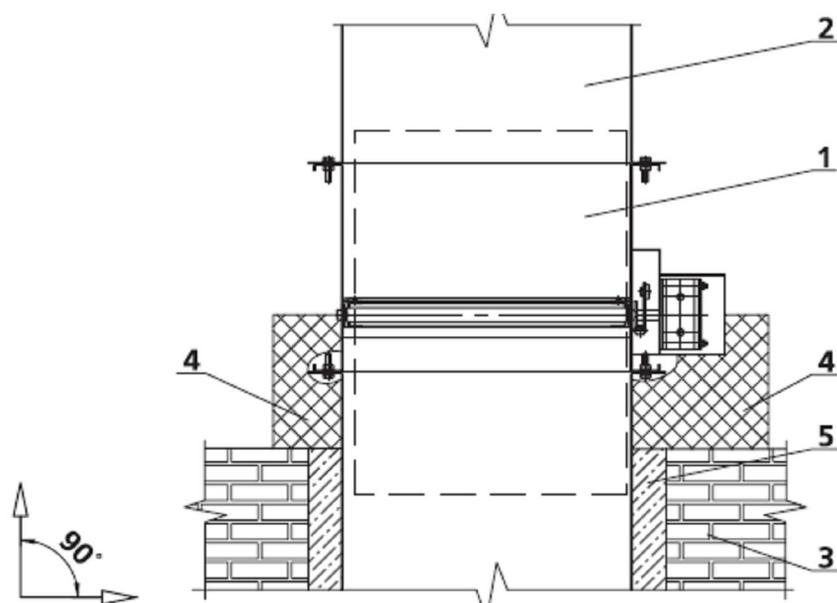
Монтаж клапана, присоединяемого к вертикальному участку воздуховода или потолочному перекрытию: 1 – клапан; 2 – воздуховод; 3 – перекрытие; 4 – наружная теплозащита; 5 – цементно-песчаная смесь
